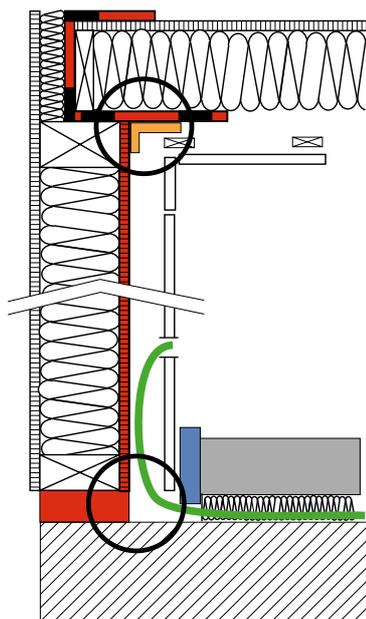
Anschluß der Installationsebene aus Plattenmaterial an einen Massivboden bzw. an eine Holzdecke.
